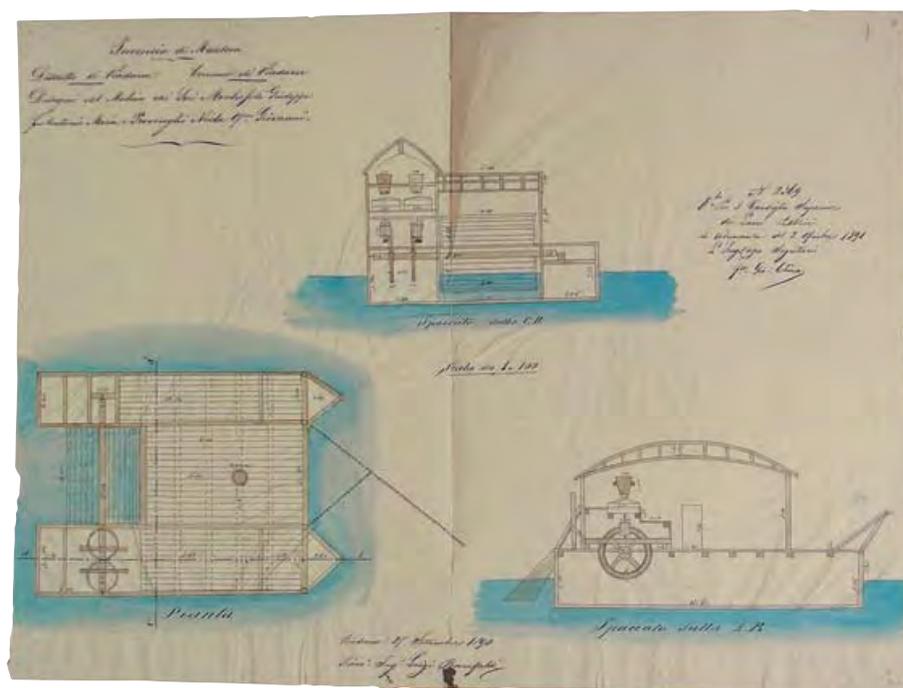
Pianta e spaccato di un mulino natante del Po, Viadana, 1890. Collezione privata.
